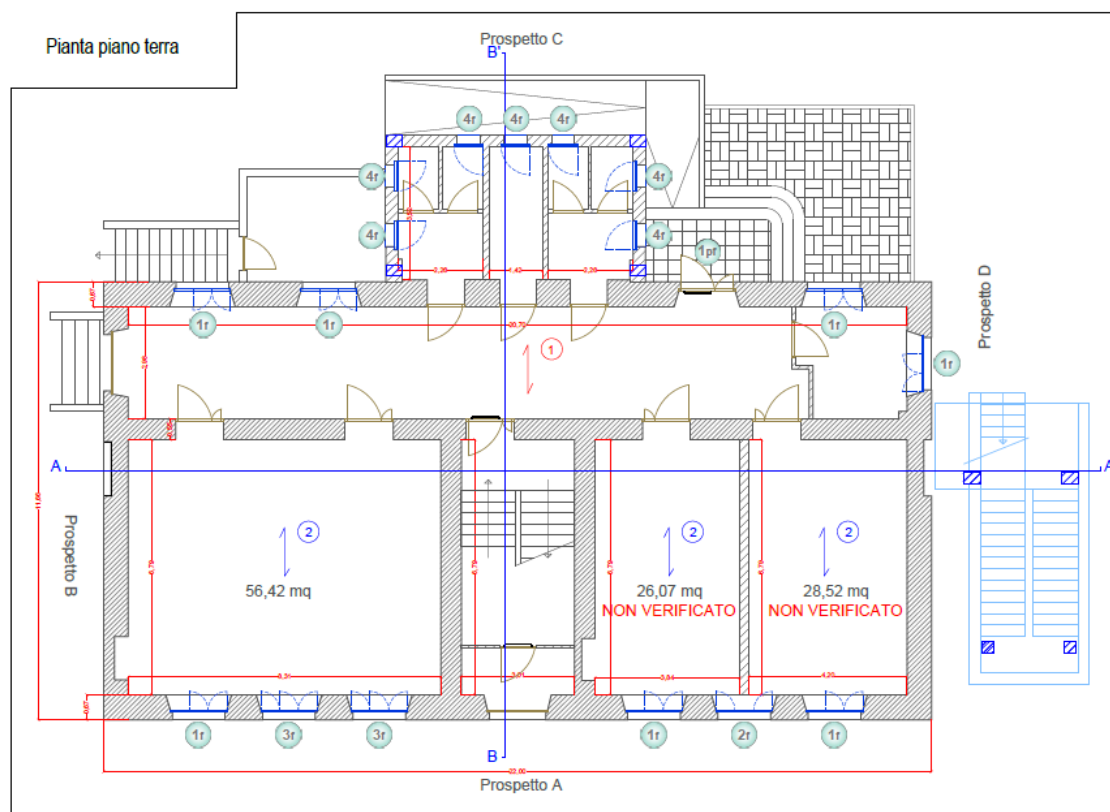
Planimetria Piano Terra con individuazione delle tipologie di solaio
